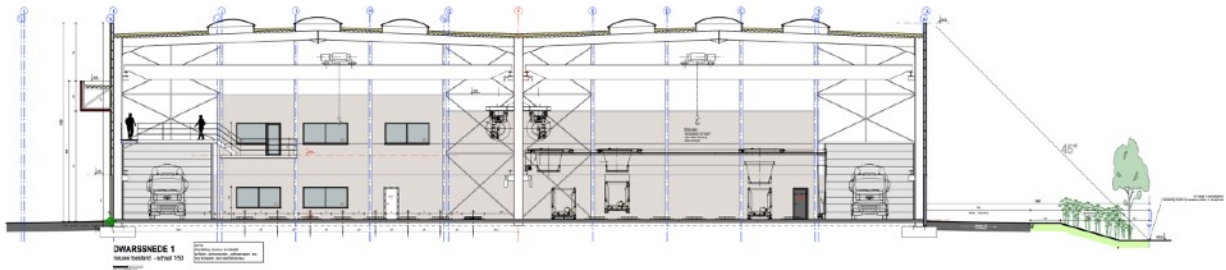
PLAN 19 Dwarssnede doorheen de fabriek. © AP/ART
